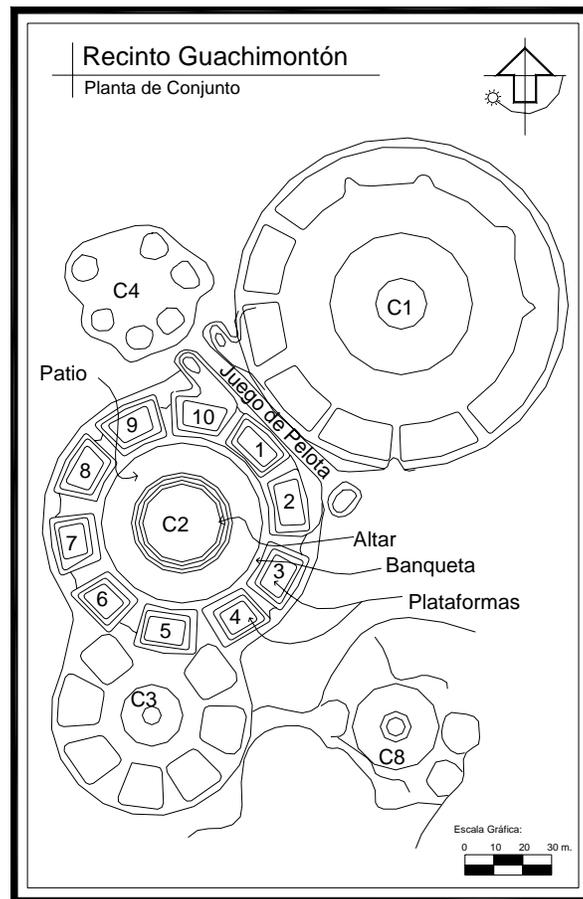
Elementos arquitectónicos de los conjuntos circulares en planta
